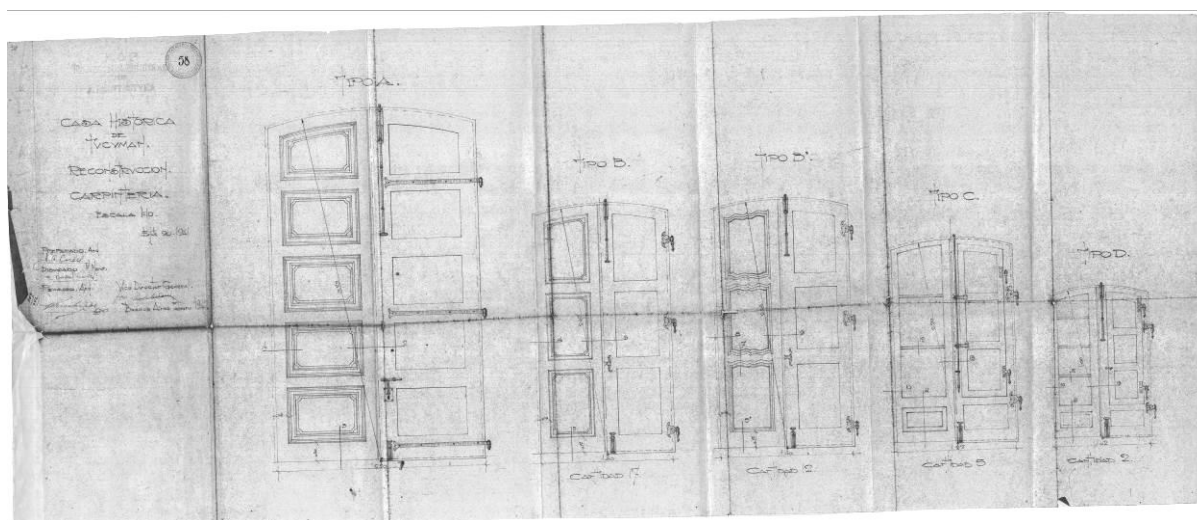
Proyecto, Planos de las carpinterías, 1941, N° 58 DNOA
